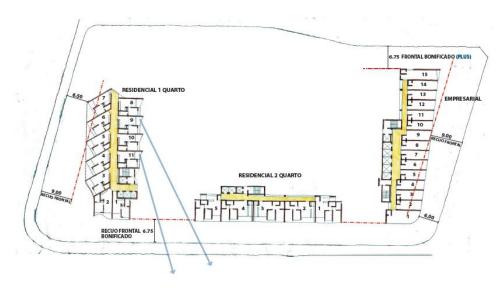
Planta Baixa do pavimento tipo da nova proposta. Fonte: Autor do Projeto
